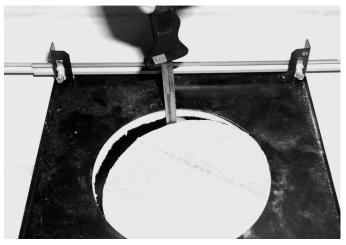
Découpe d'un trou dans la dalle de plafond
